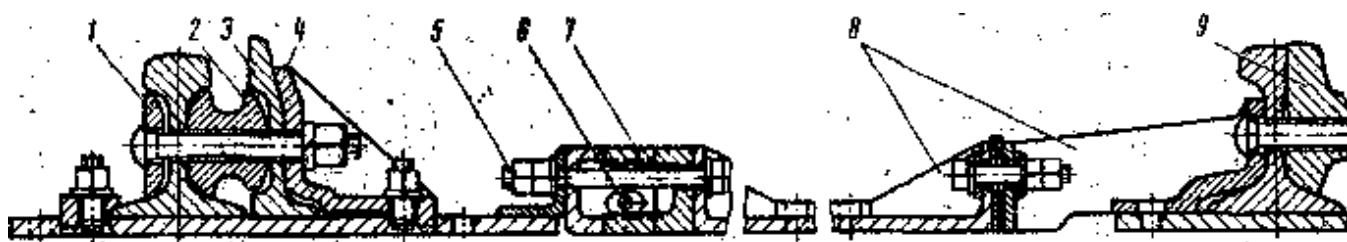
Контррельс в сборе с путевым рельсом и крестовинной распоркой:
